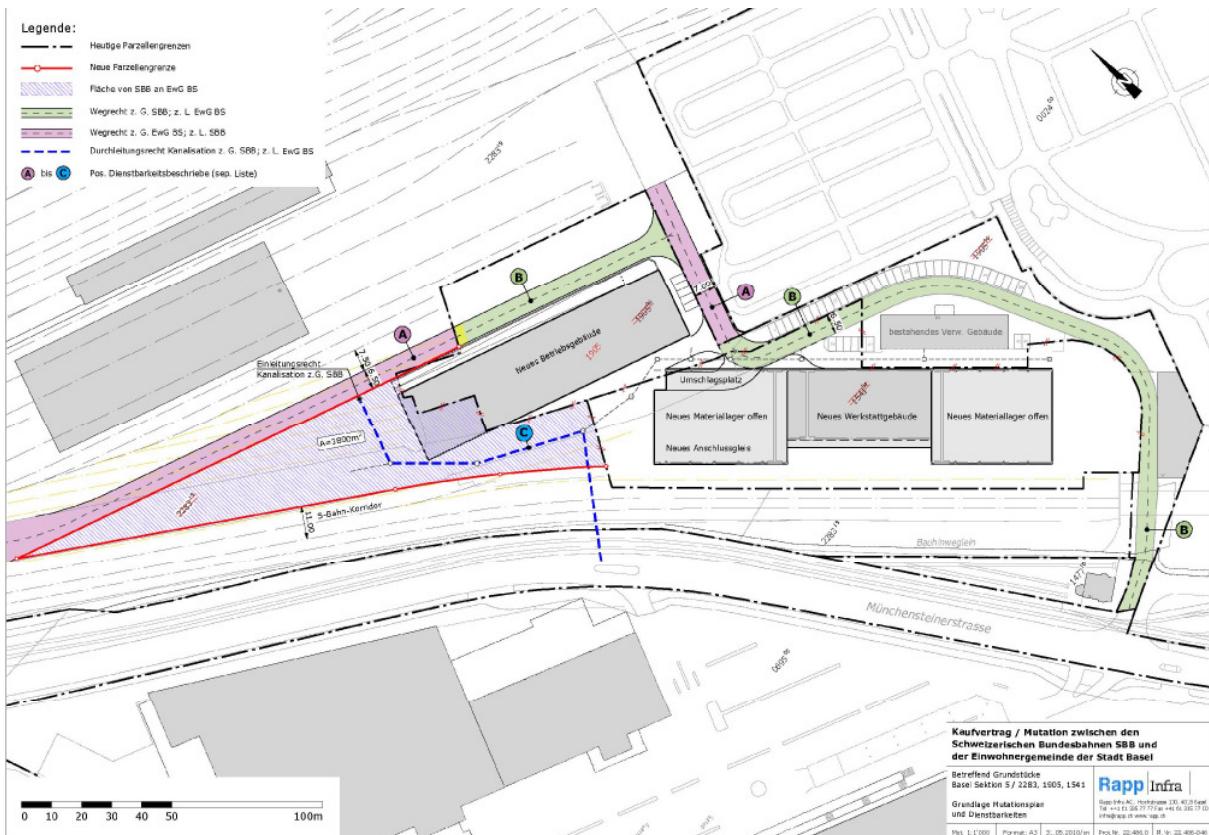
Übersicht Landabtausch, Dienstbarkeiten. (Ohne Massstab, Plan nicht genordet. Quelle BVB / Rapp Infra, 2010)
